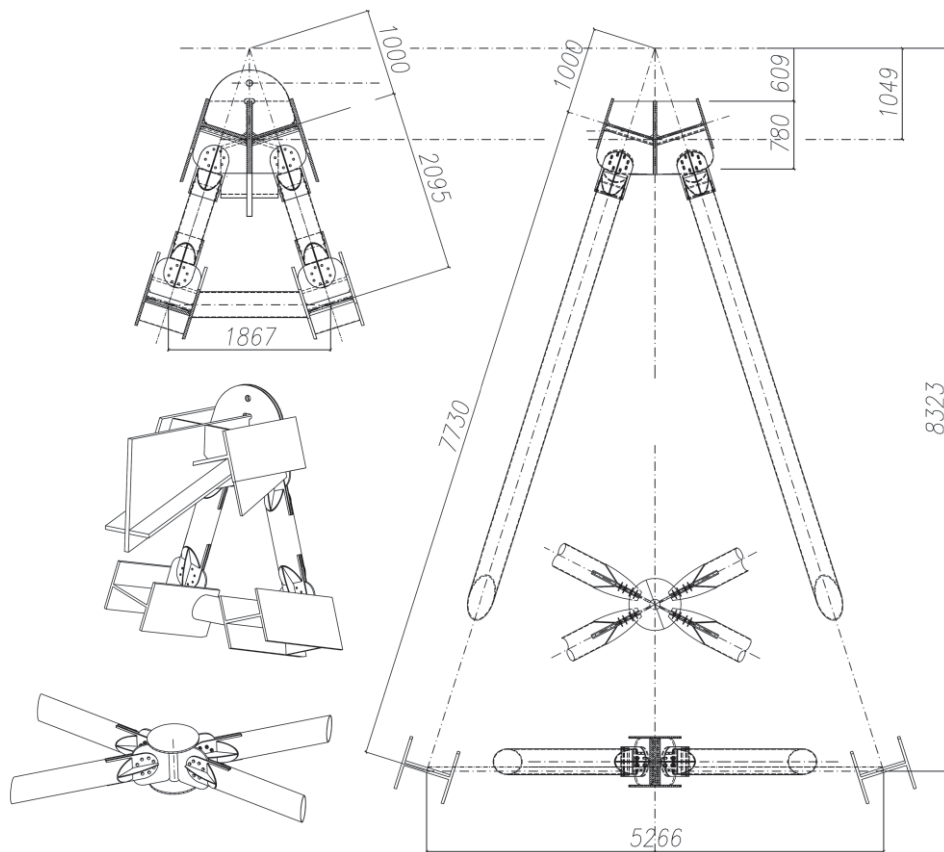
Vista in sezione e dettagli della trave reticolare longitudinale
